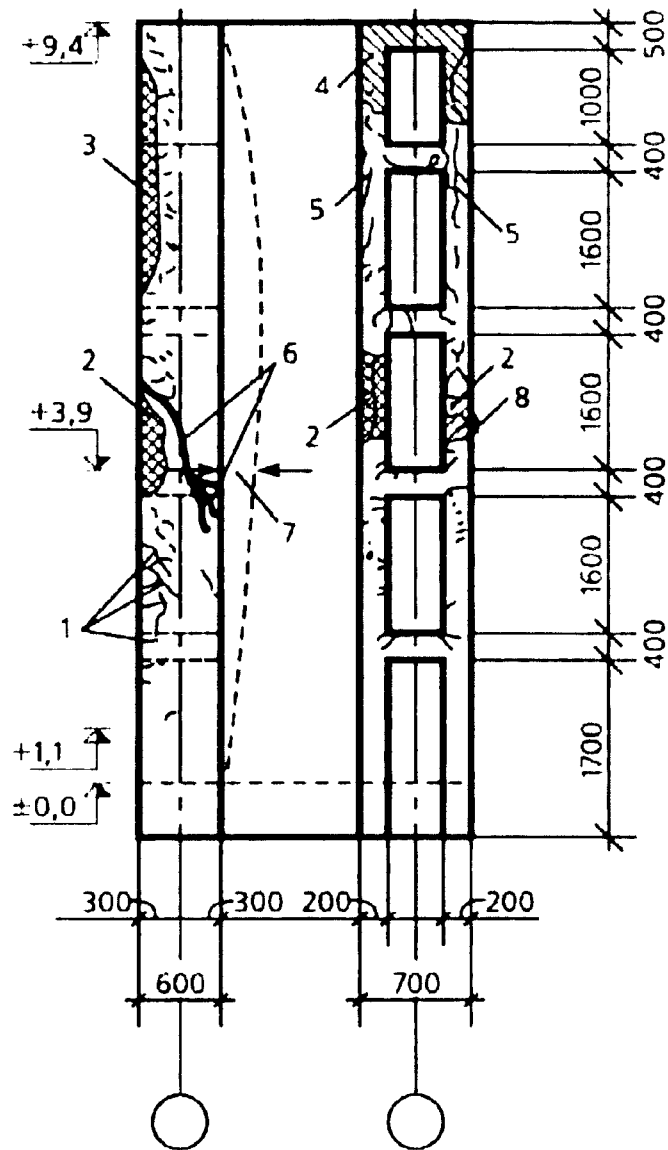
Характер повреждения огнем колонны несущего каркаса: 1 - поверхностные трещины шириной 0,5-1,5 мм; 2 - выкрашивание разрушенного бетона; 3 - отслоение защитного слоя бетона; 4 - участок перекаленного бетона белого цвета; 5 - продольные трещины в защитном слое бетона от температурного расширения арматуры; 6 - сквозные трещины шириной 2-8 мм; 7 - остаточный прогиб колонны вследствие температурной деформации ригеля; 8 - выпучивание и перегрев продольной арматуры
